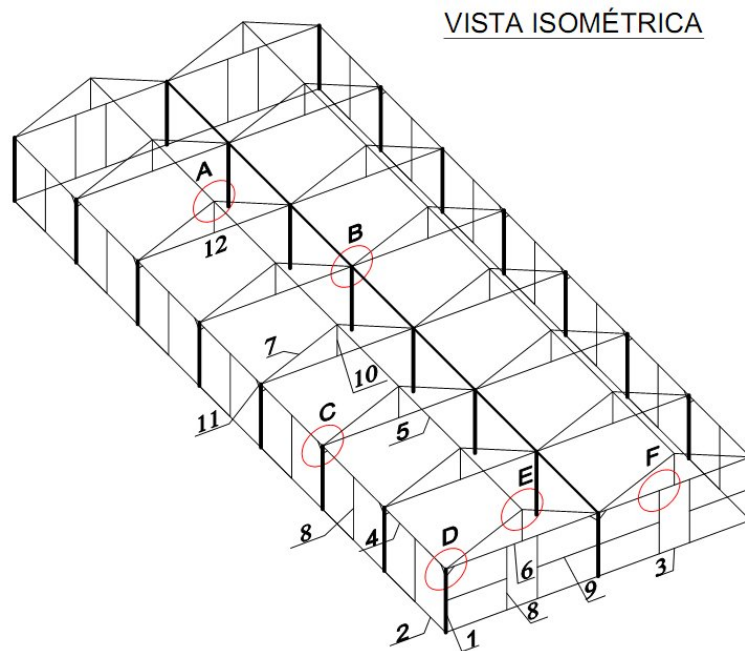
Detalles de construcción de un invernadero con estructura de madera.
